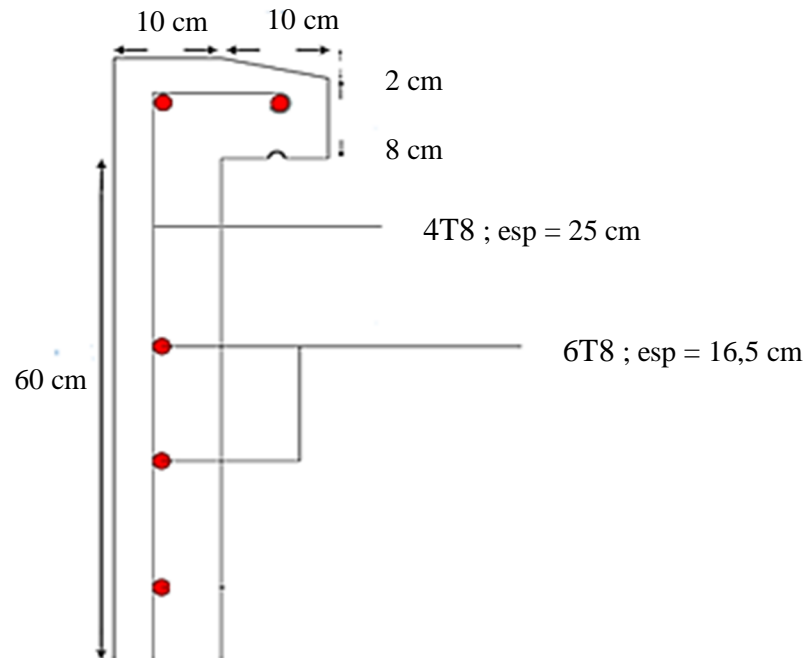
Schéma du ferrailage et coffrage de l'acrotère
